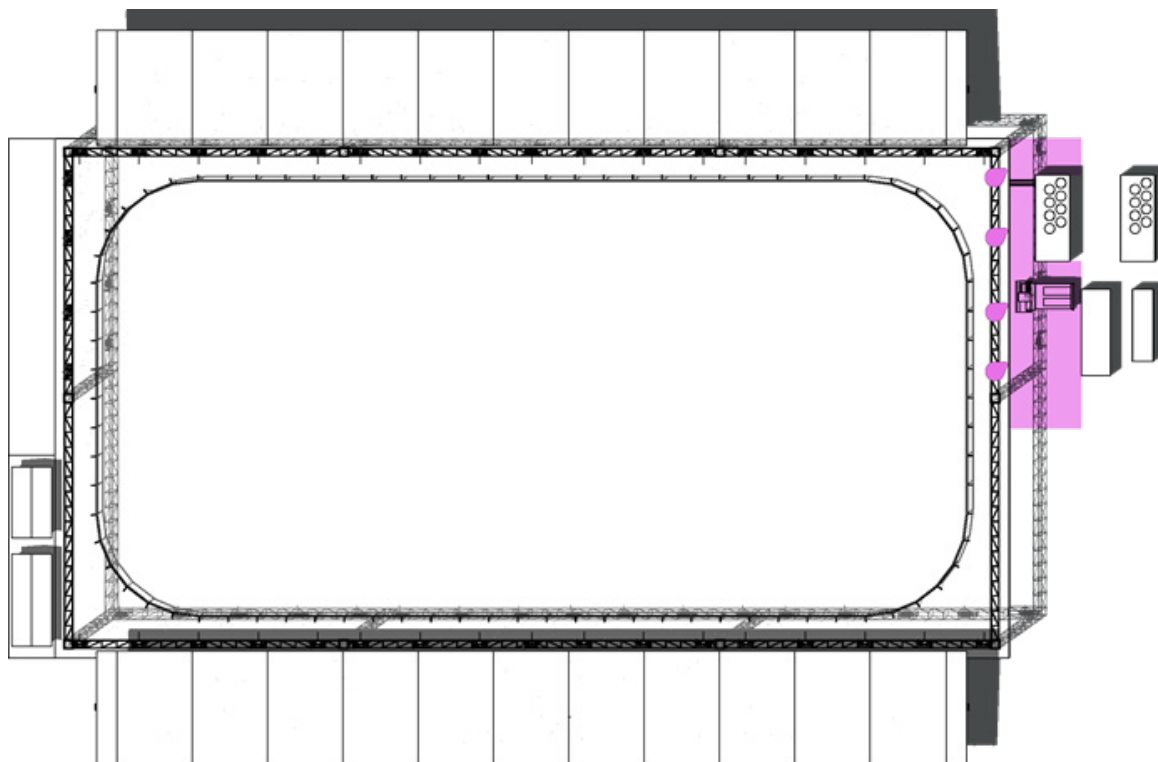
disposizione degli apparecchi per l'illuminazione dell'area impianti
